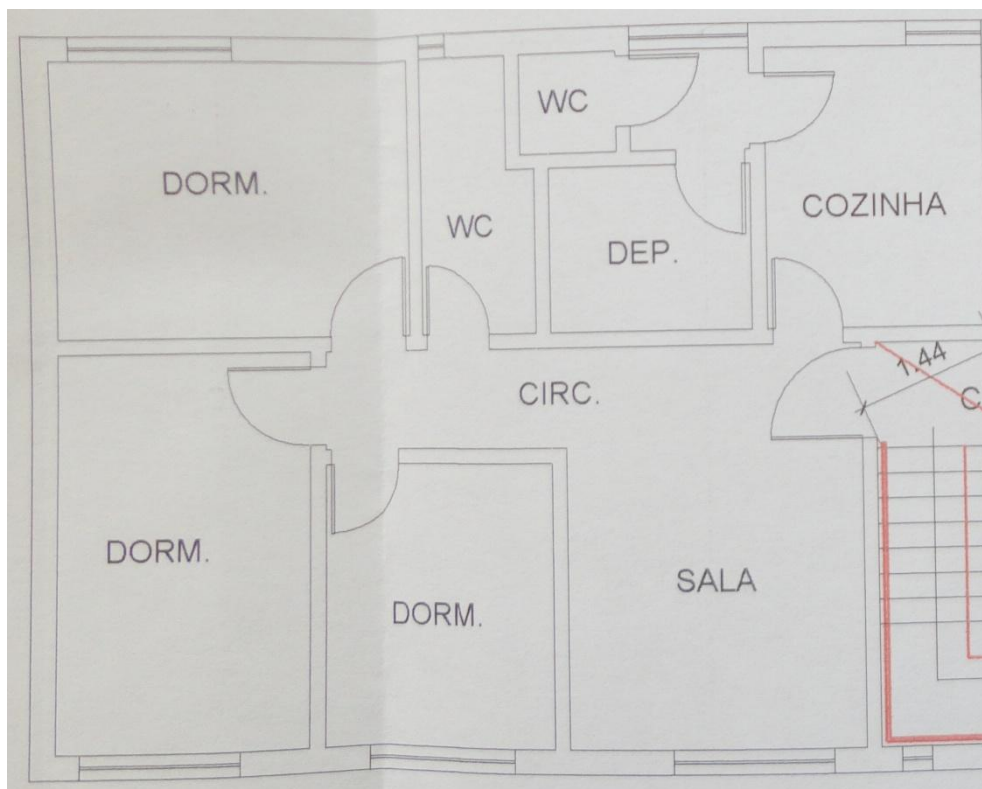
Planta do apartamento de três dormitórios do Plano 1 do condomínio Cohabpel
